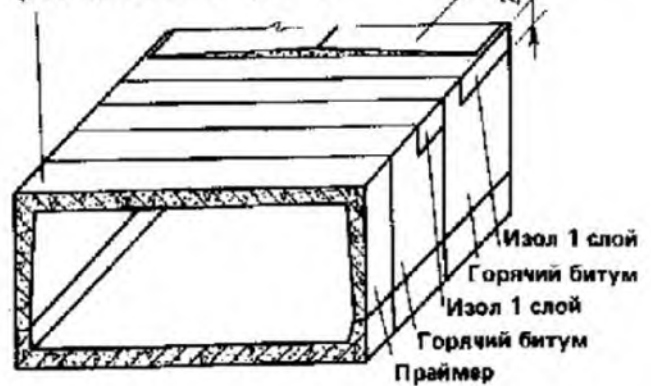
Гидроизоляция поверхностей стен и перекрытий канала
